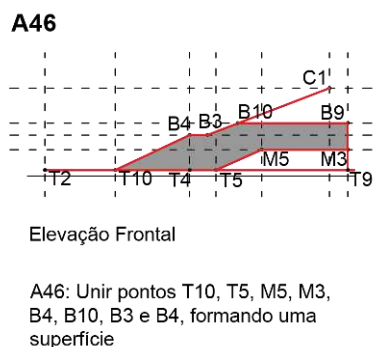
Criação de um plano envidraçado vertical na fachada a partir da ligação de pontos criados no térreo, mezanino e primeiro pavimento (Ação 46)
